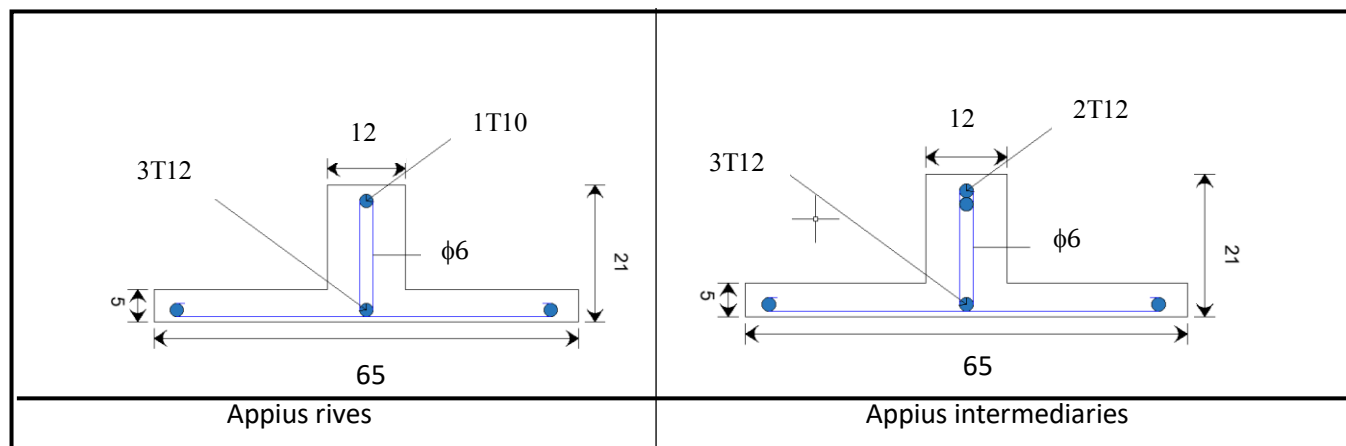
dessin de ferrailage des poutrelles des étages courants.
